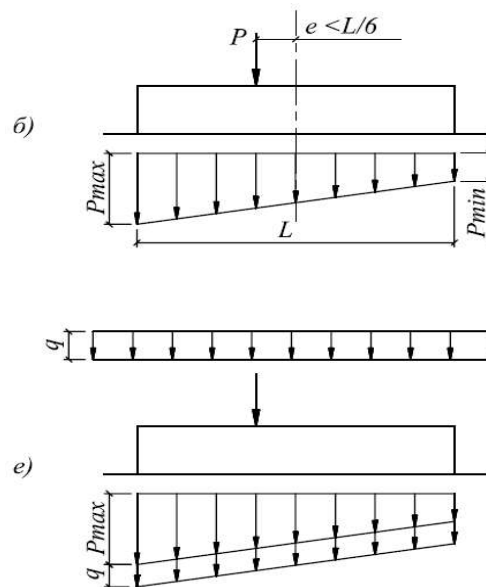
Эпюры давлений по подошве фундаментов при внецентренной нагрузке. б и е – при эксцентриситете нагрузки
